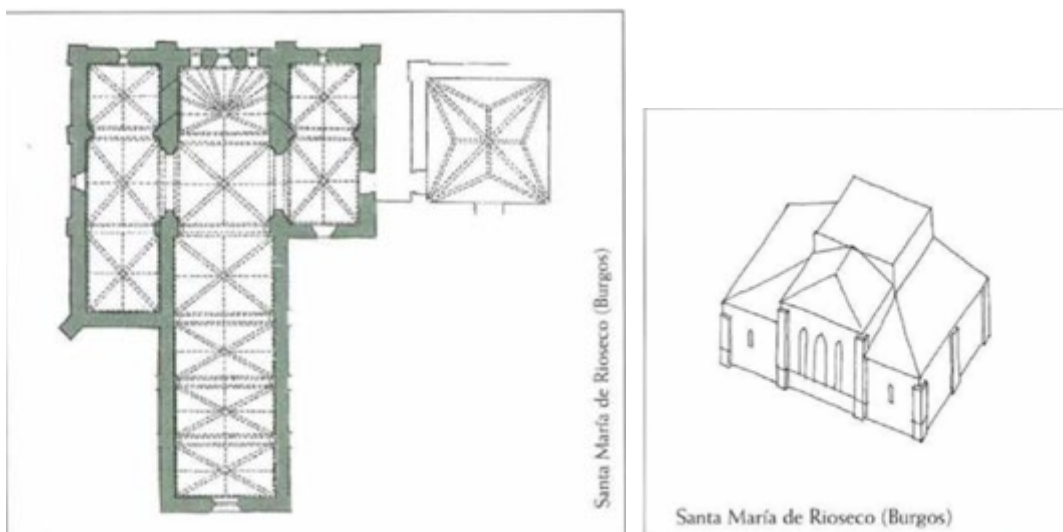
, 78: Rioseco, Santa María, Kirche, Grundriss und Chorabschluss, 1998.
